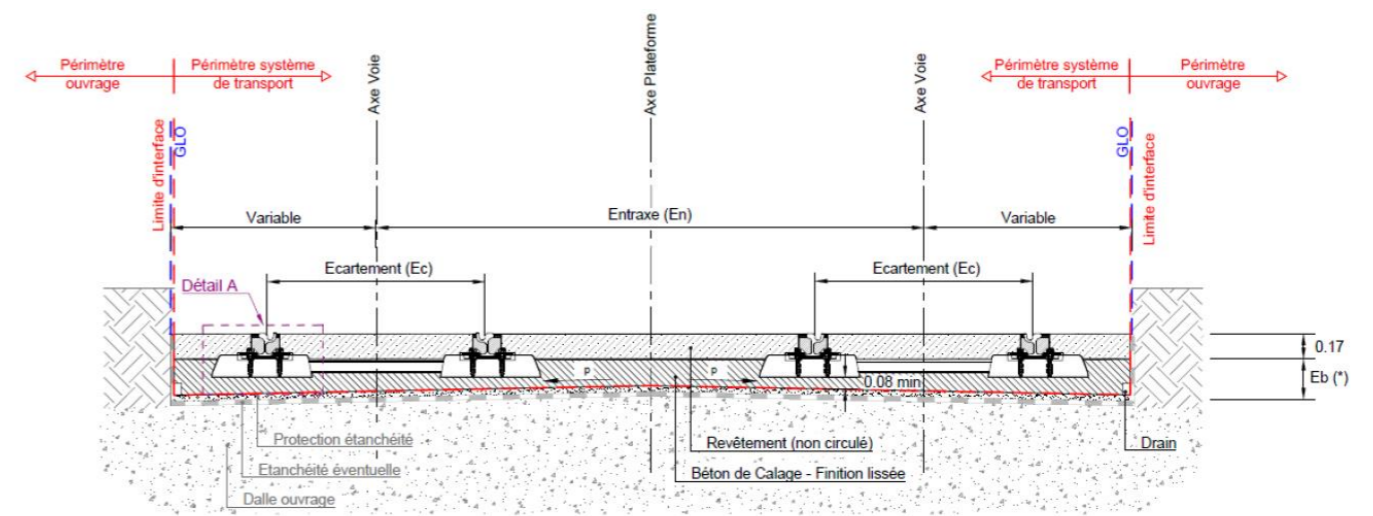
coupe type d'une plateforme - Voie béton traverses - Sans béton de fondation sur ouvrage
